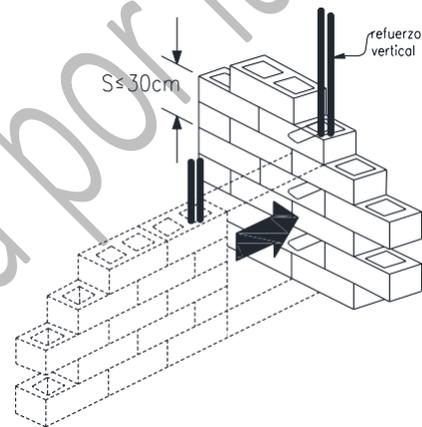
Conectores entre muros sin traslape de piezas
